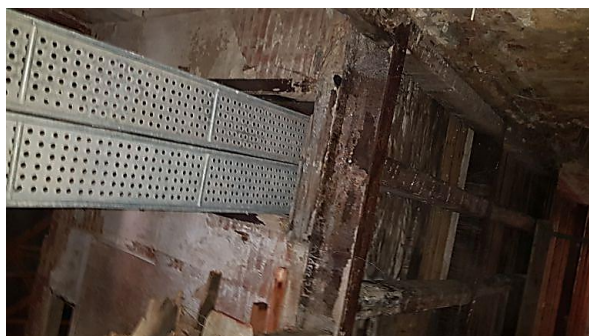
, 17 – Provizorní podepření stropní konstrukce nad 2.n.p. – napadení dřevokaznou houbou a plísněmi
